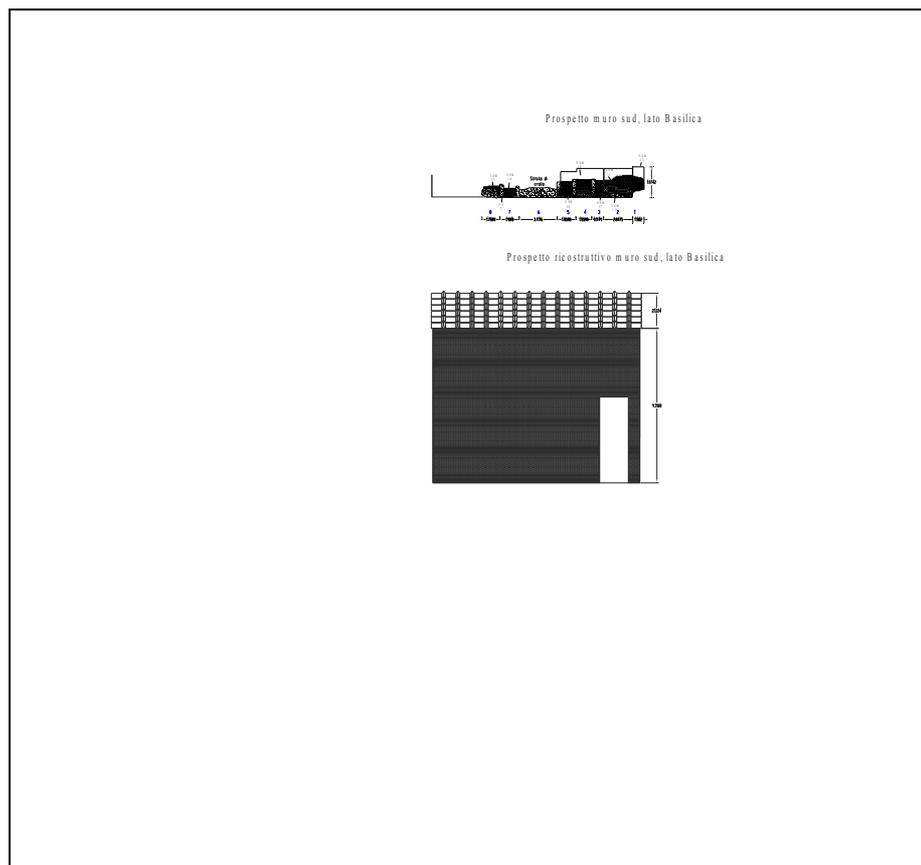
Prospetto ed ipotesi ricostruttiva muro sud, lato Basilica.
